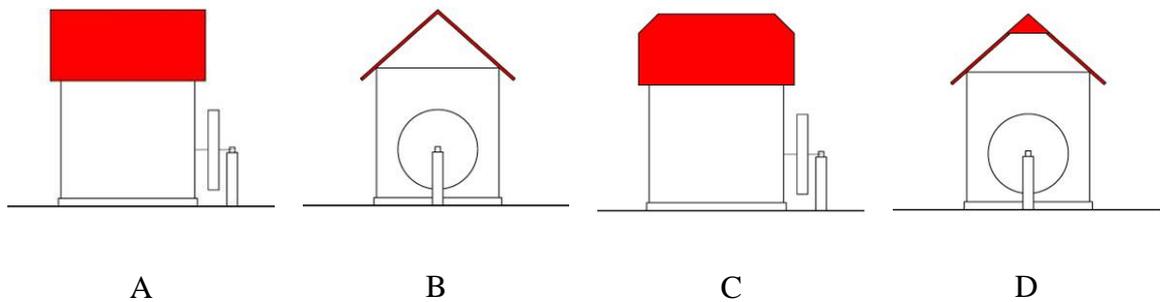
Formen der Dachausbildung bei Mühlegebäuden
